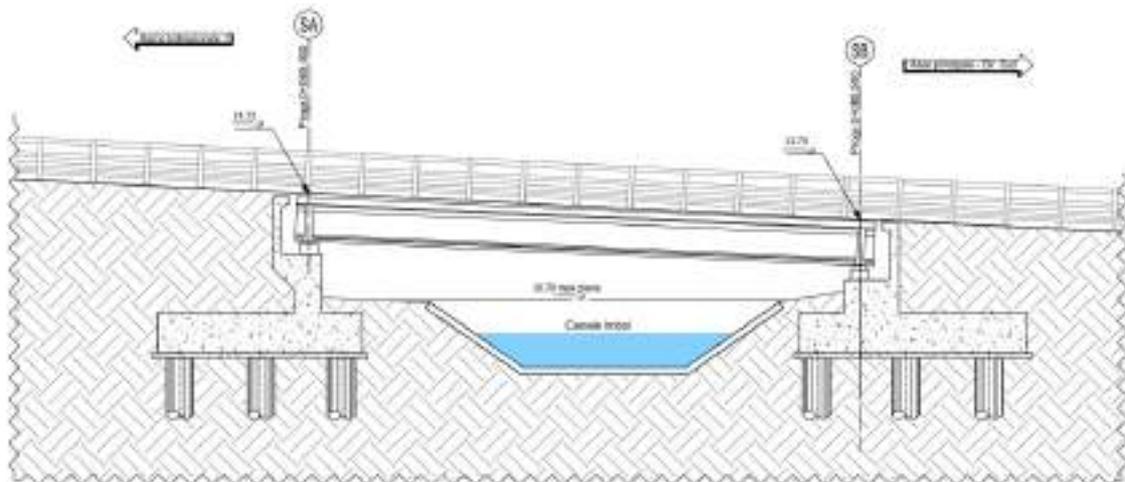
Prospetto del ponte su canale Imboi svincolo Capoterra - Casic ramo B.
